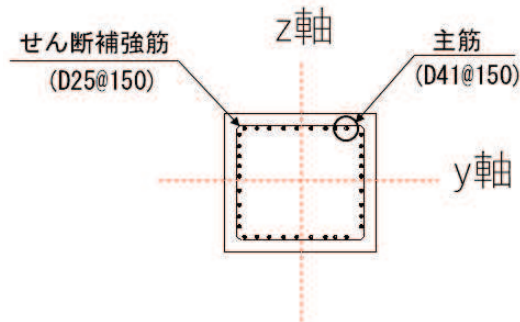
RC 支柱の配筋概要図（鋼製扉 3 の例）
